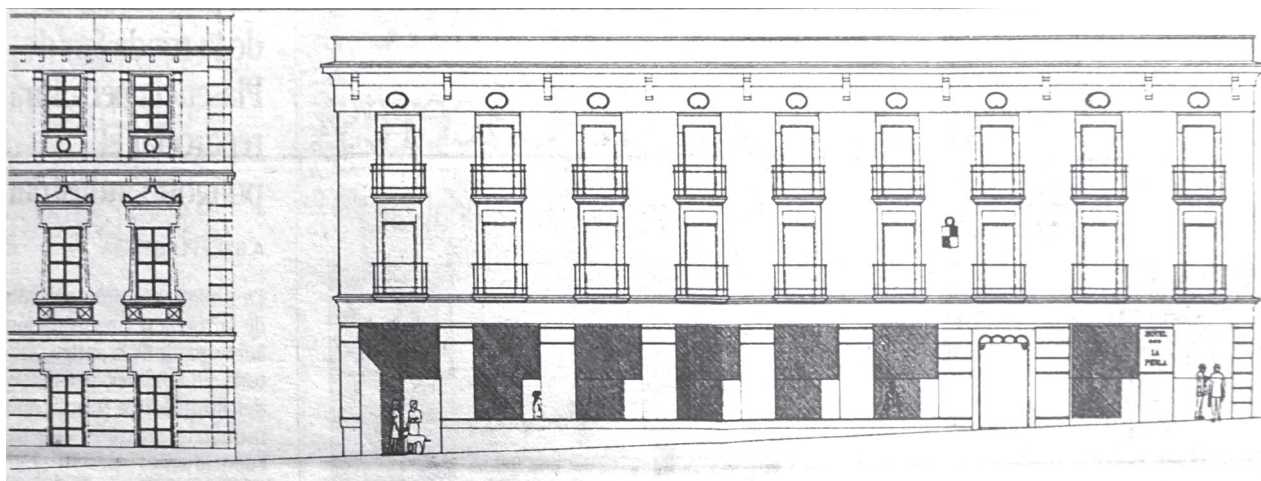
Fachada del hotel proyectado que realizó el arquitecto Francisco Escudero Pintado
